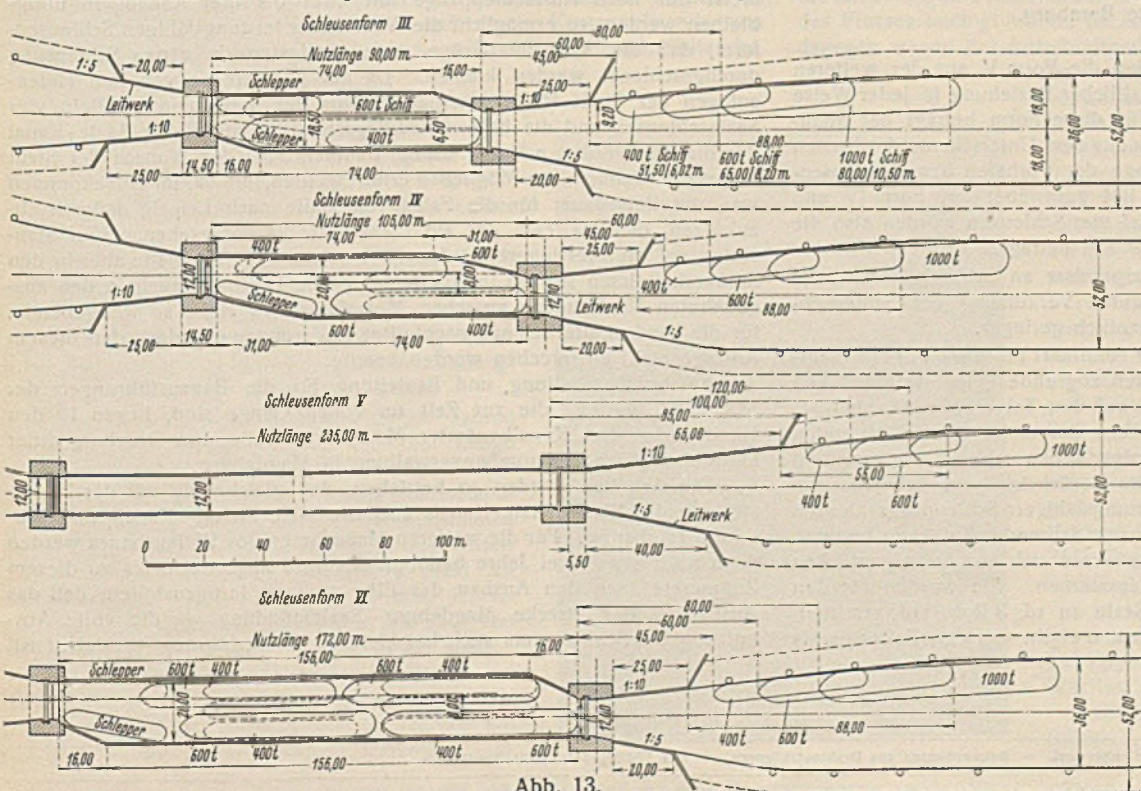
Verschiedene Grundrißformen für die Saaleschleusen.
